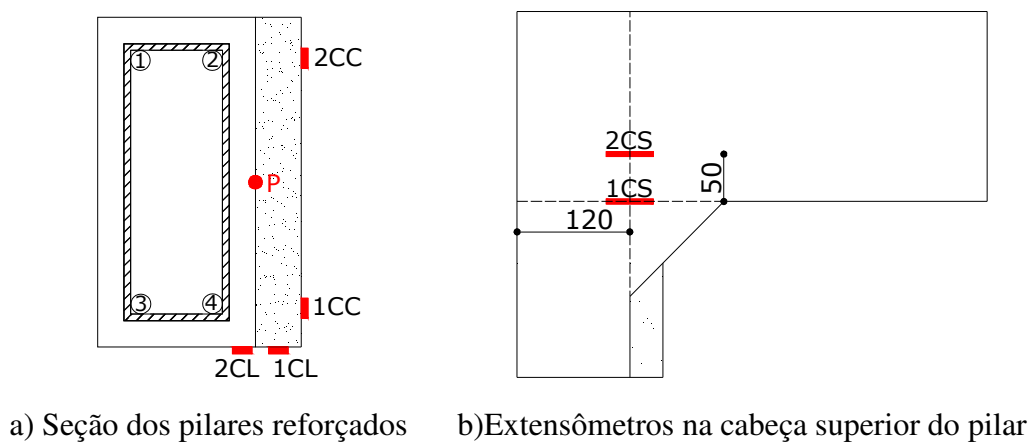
Posicionamento dos extensômetros de concreto nos pilares reforçados, unidades em milímetros
